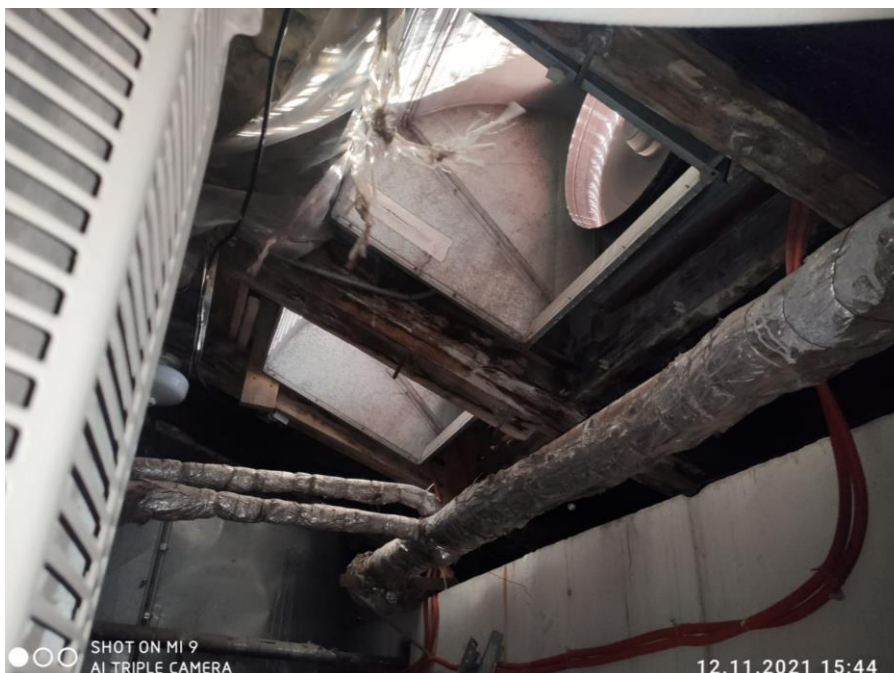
Смонтированные вентиляционные установки п1.1 (2шт.)
